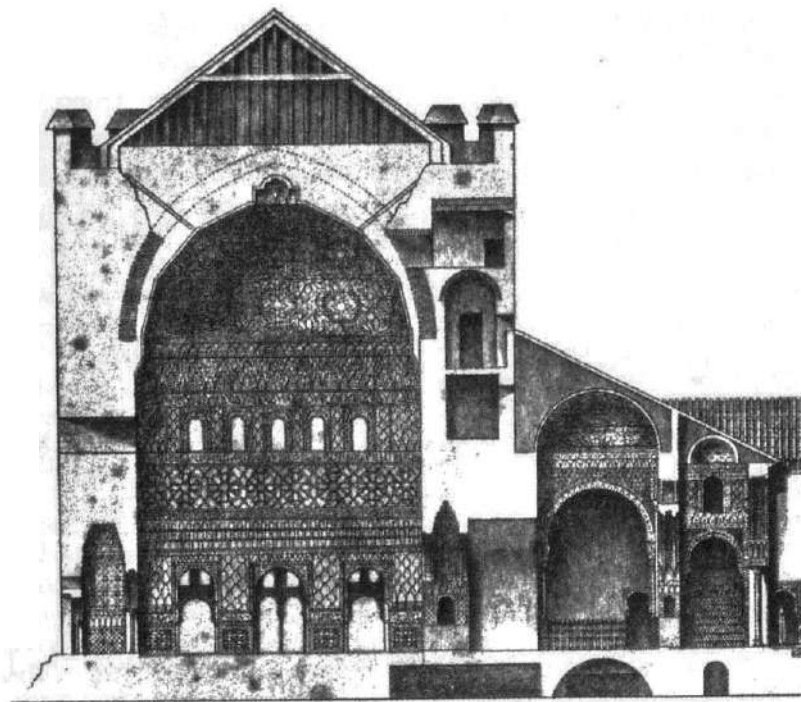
Corte transversal de la Torre de Comares de norte a sur. En esta sección se nos muestra el formato de armadura que posiblemente fuese similar al elegido en el momento de su creación en 1689. Girault de Pragney, 1833.
